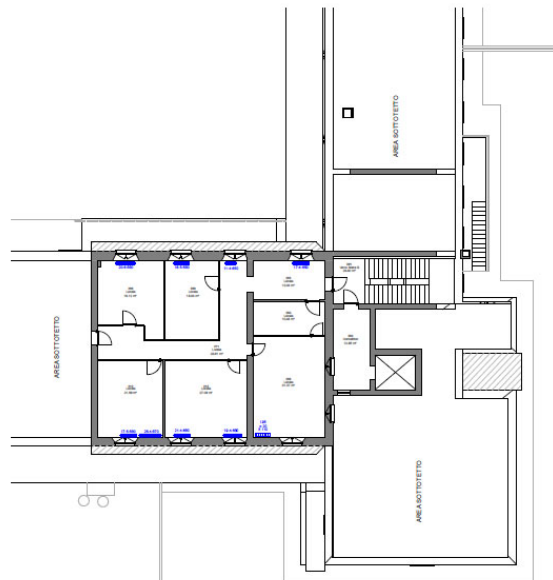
Planimetria piano terra dello stato di fatto
